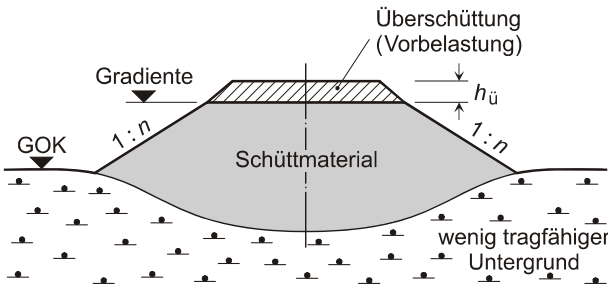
Vorbelastung eines Straßendamms zur Vorwegnahme der Setzungen aus Oberbau und Verkehrslasten (nach [238])
